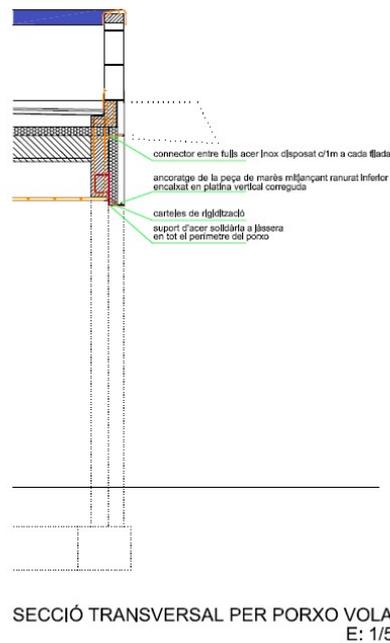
Detalle de la estructura en el porche volado previsto en el anteproyecto.
